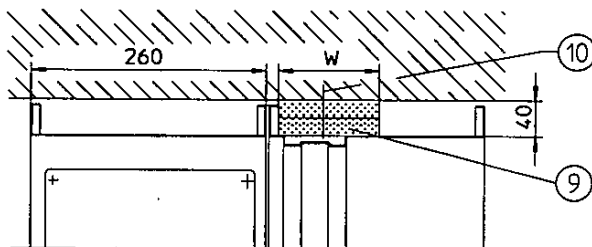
Wand- / Deckenanschluss mit Isolierstoffstreifen
